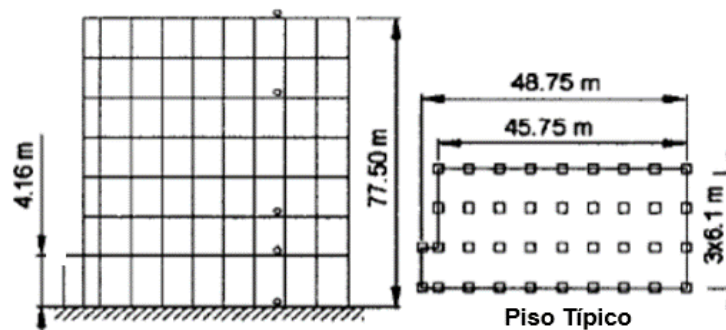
Planta y elevación instrumentada edificio 7 pisos de concreto reforzado en Van Nuys, California.
